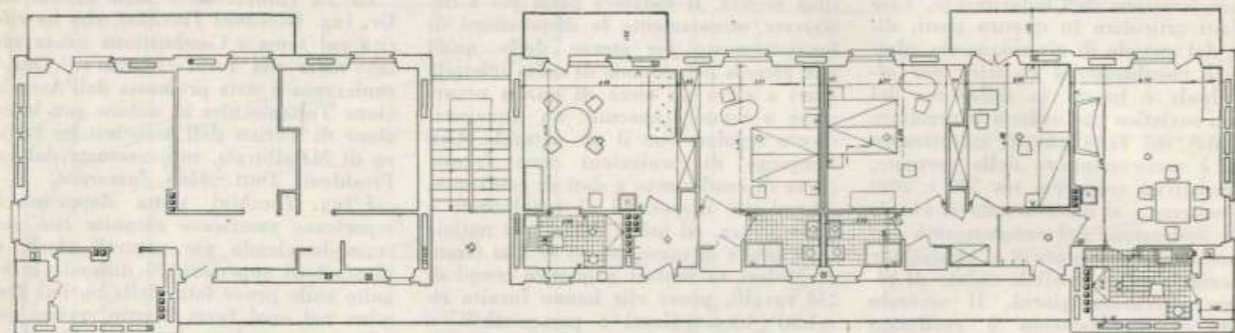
Pianta piano tipo: Motto "Nord-Sud A".
